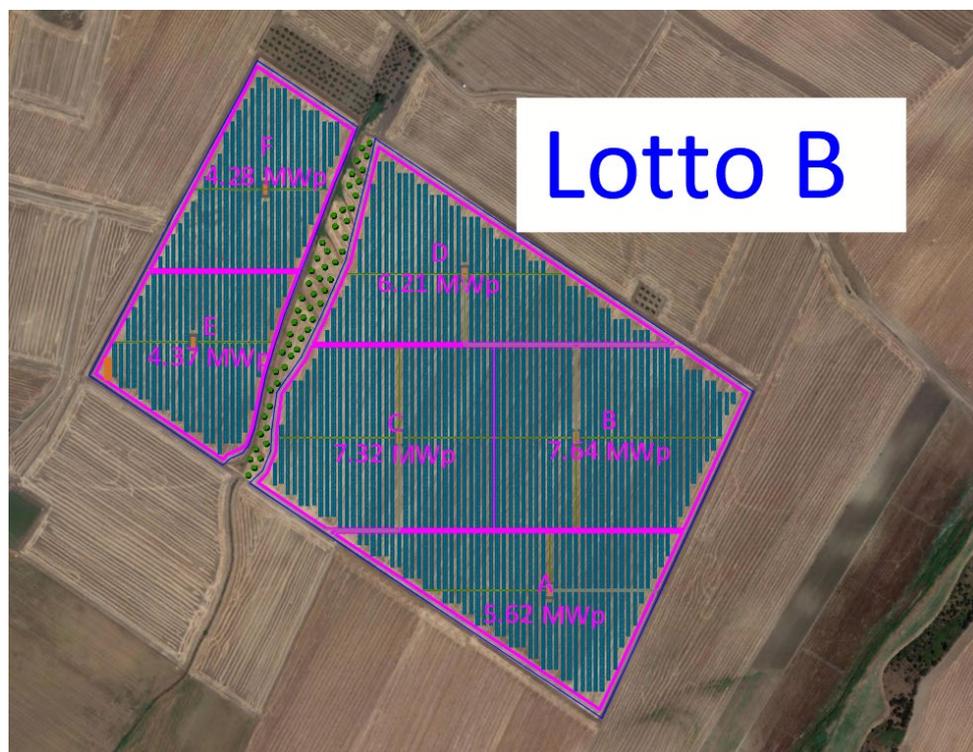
Suddivisione dell'impianto in sottocampi – Lotto B
